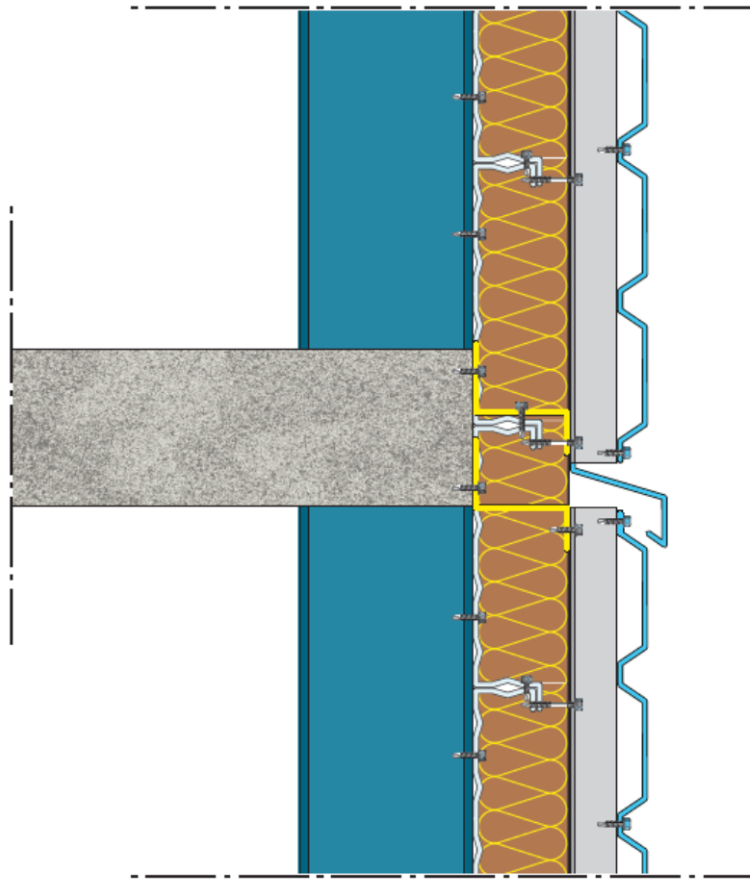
Exemple d'interruption au droit d'un plancher en zones sismiques
